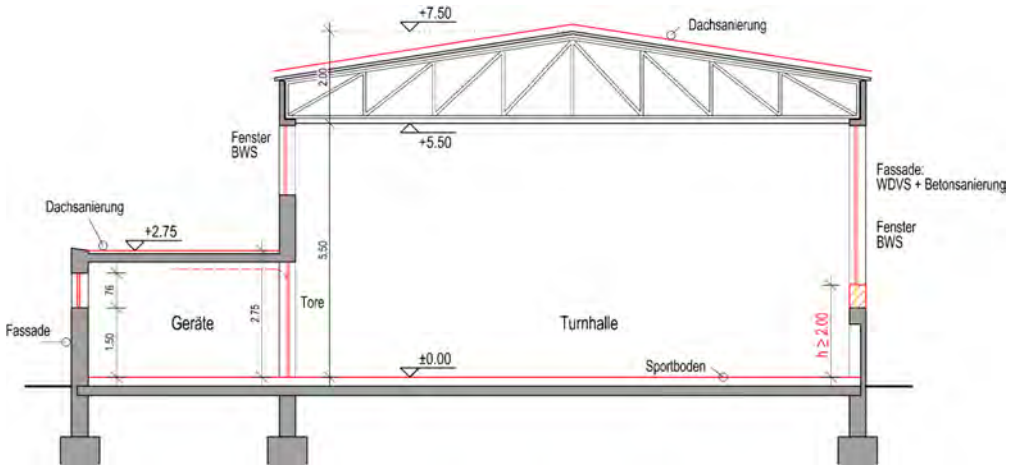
Hallenquerschnitt mit Bauteildarstellungen auf Grundlage der Bestandsunterlagen, Darstellung der geplanten Sanierungsmaßnahmen (rot)
